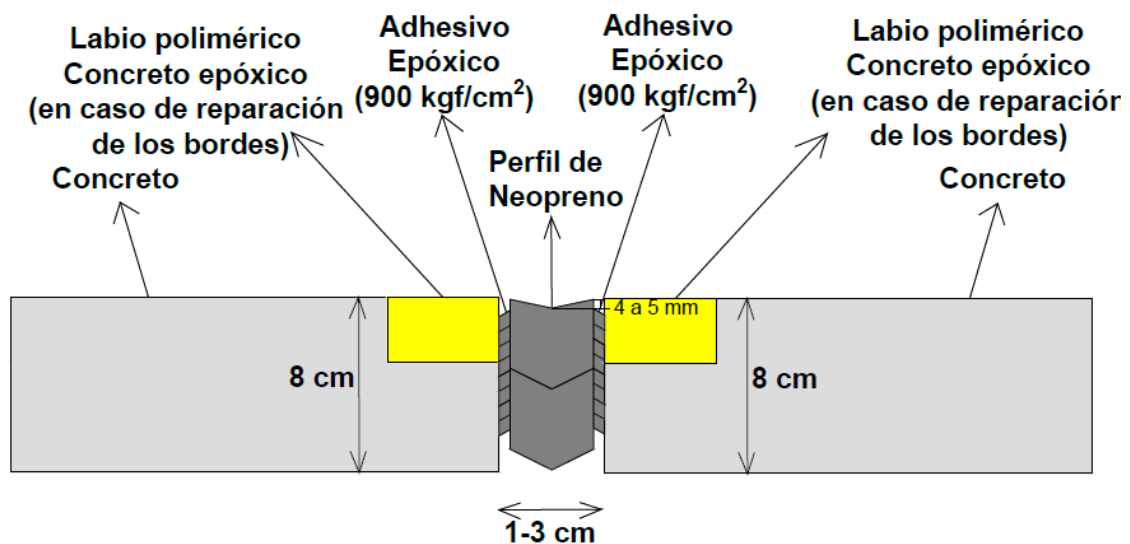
Sellado de Fisuras y Grietas, Sellador de Resina Epóxica, corte transversal.
